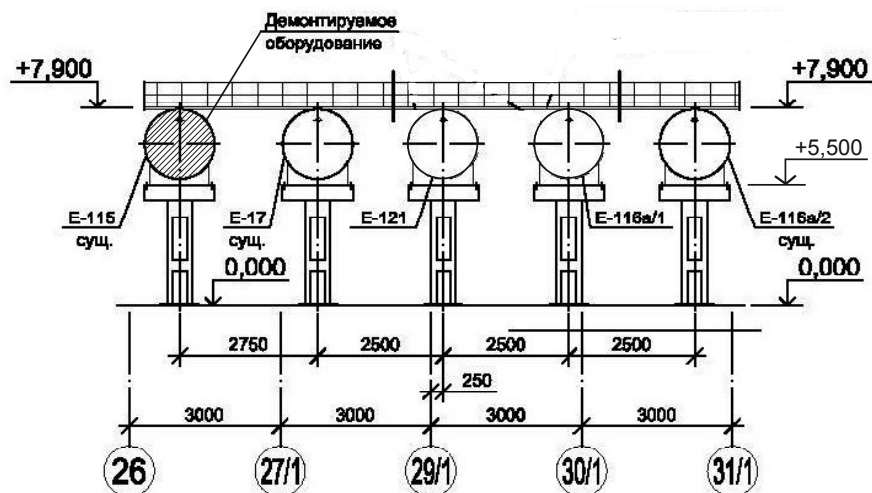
Расположения ёмкостей на отметке 5,5 м на распределительных балках железобетонных опор
